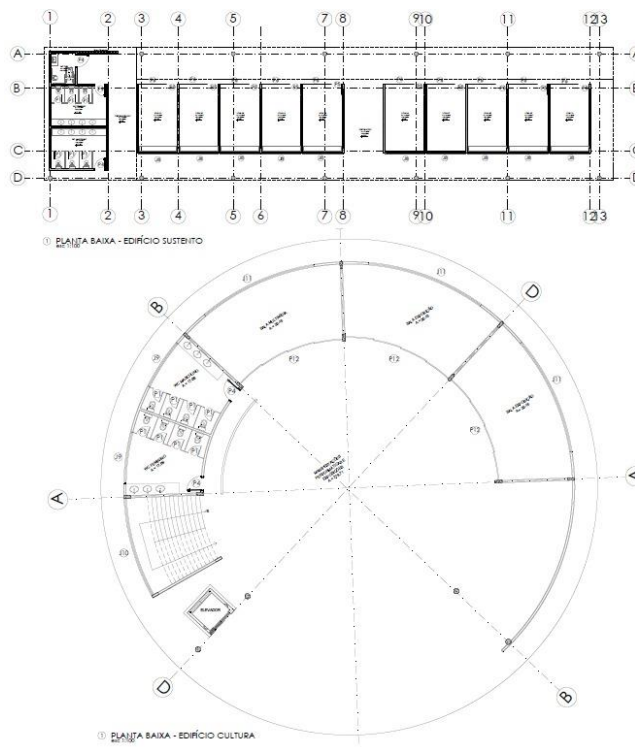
Planta Baixa – Ed. Sustentivo e Planta Baixa Térreo Ed. Cultura
